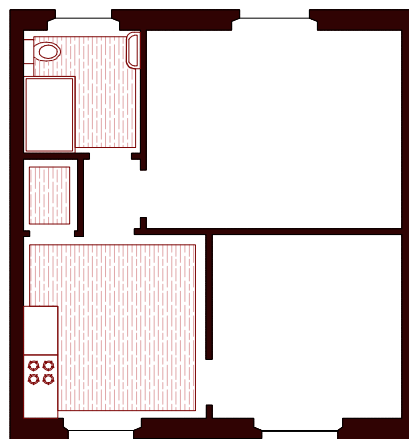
Planta piso térreo habitação extrato baixo - CMP
